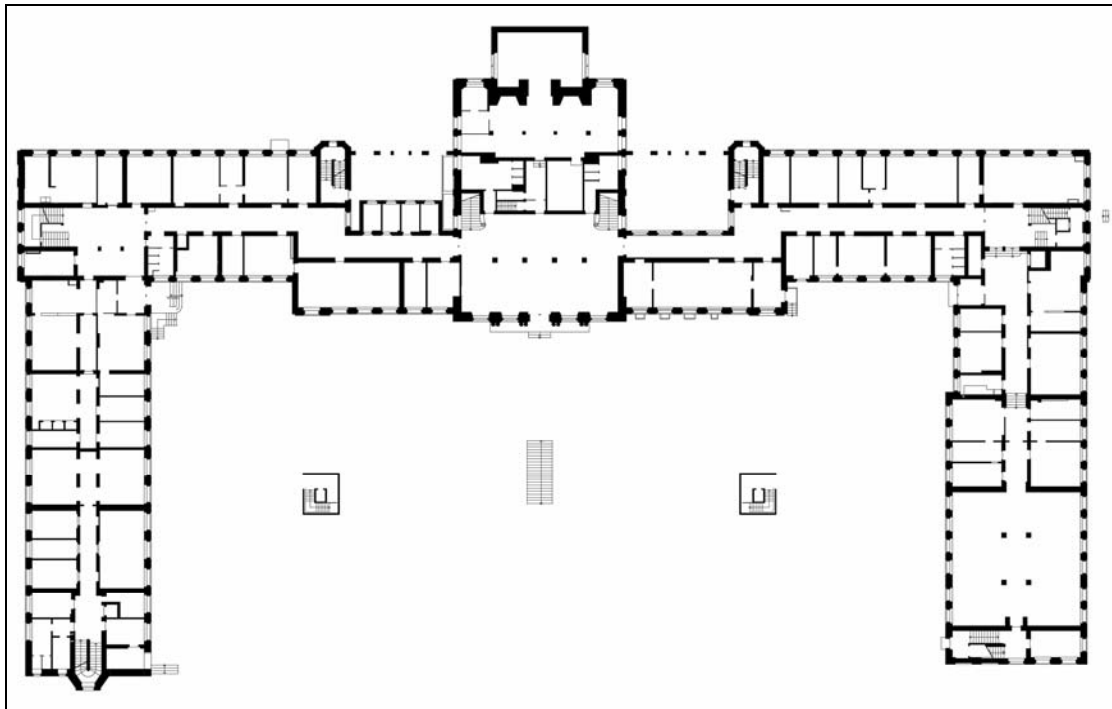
Grundriss (Fritz-Foerster-Bau, Technische Universität Dresden)
